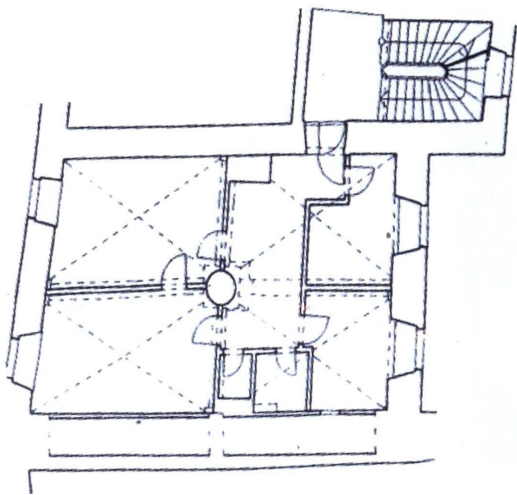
Grundriss der Dominikuskapelle, zweites Obergeschoss.
